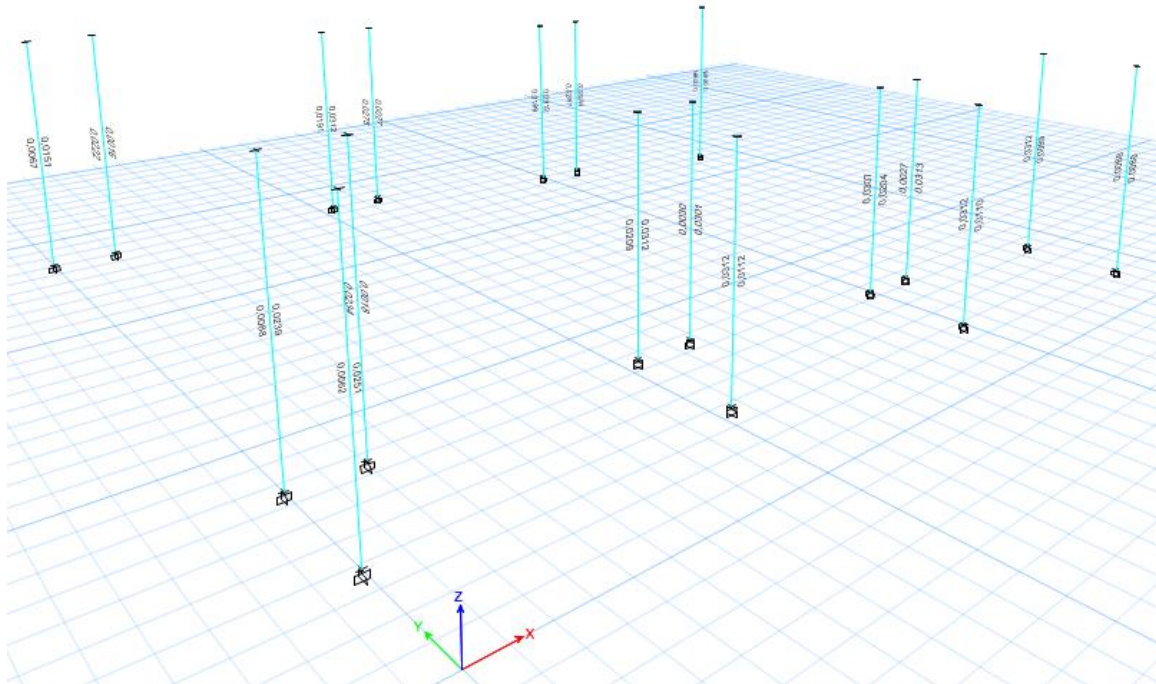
Refuerzo transversal en columnas de las aulas polivalentes en cm²
